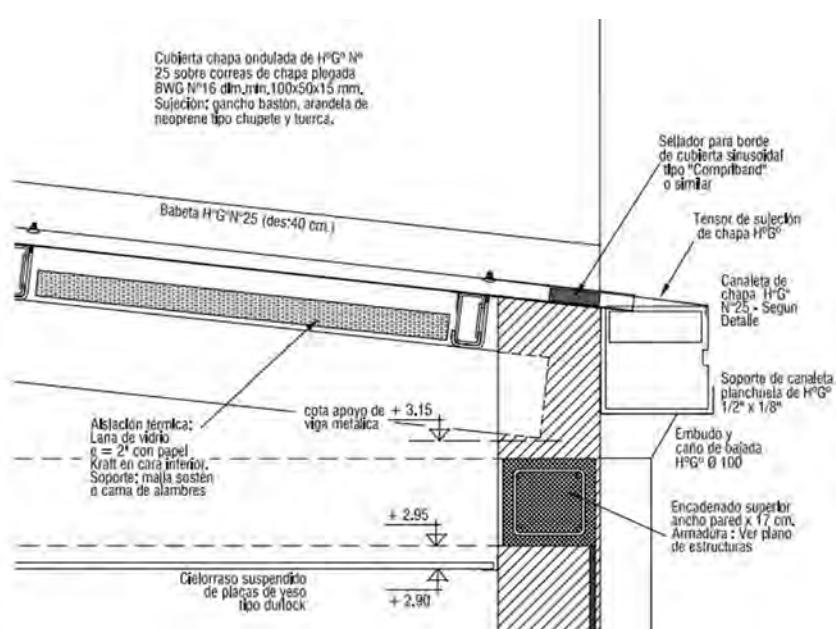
Detalle de encuentro de techo muro cielorraso PT60. Fuente: legajo técnico INVICO
